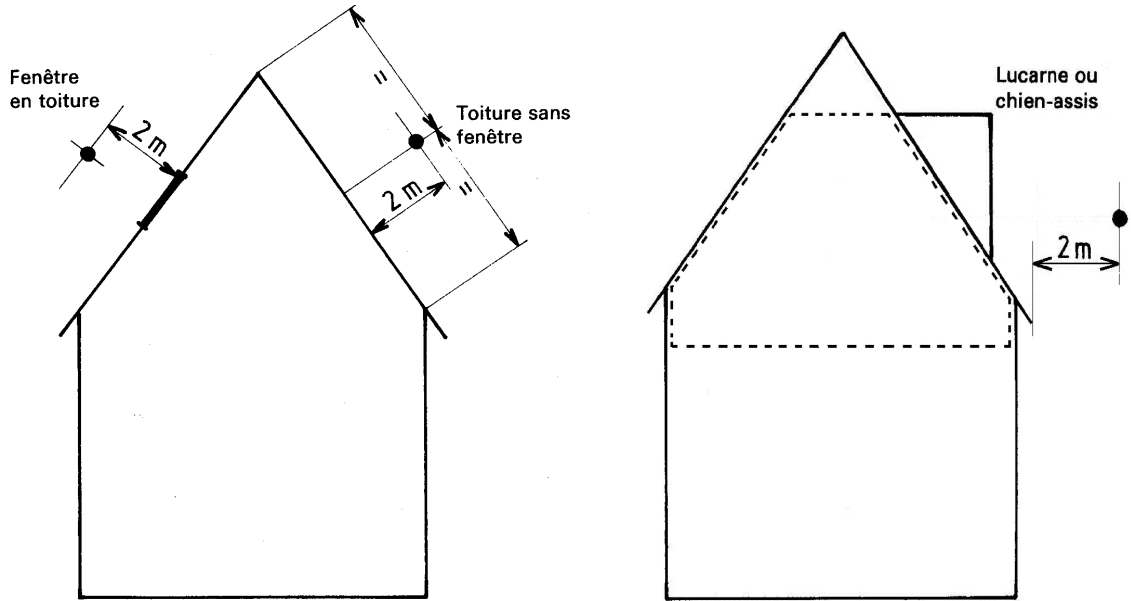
Définition de la distance à la façade pour les toitures.
